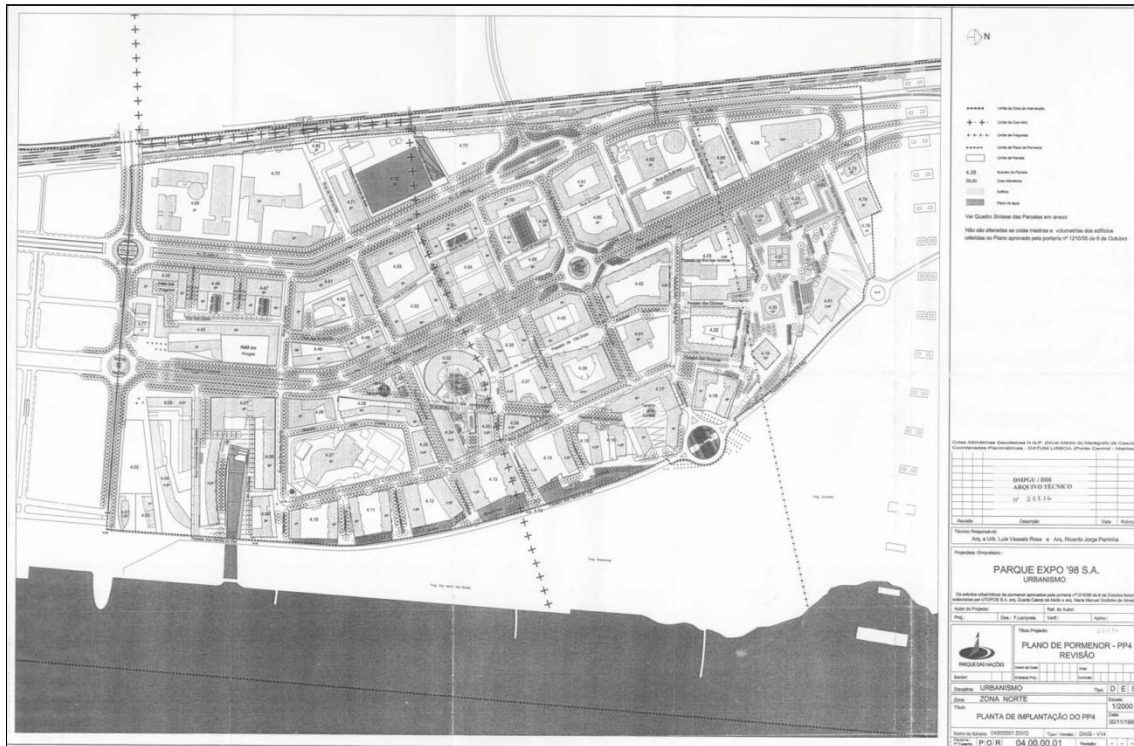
Planta do Plano de Pormenor n.º4: Zona de Beirolas
